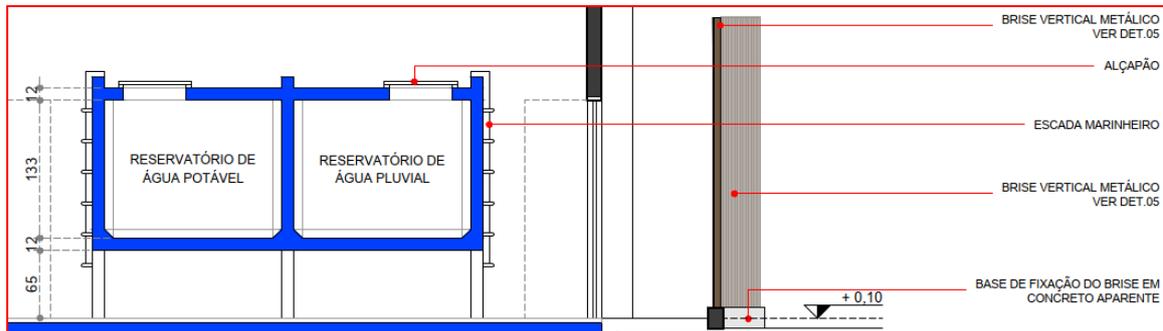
Detalhe de Escada Marinheiro e porta alçapão - Fonte: CEASA/PR e ARCHSALLES
